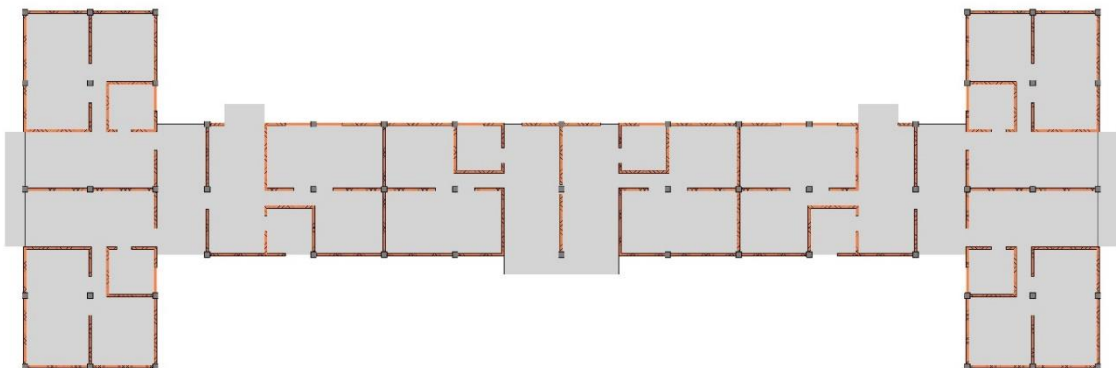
Pianta architettonica dei piani primo, secondo e terzo
